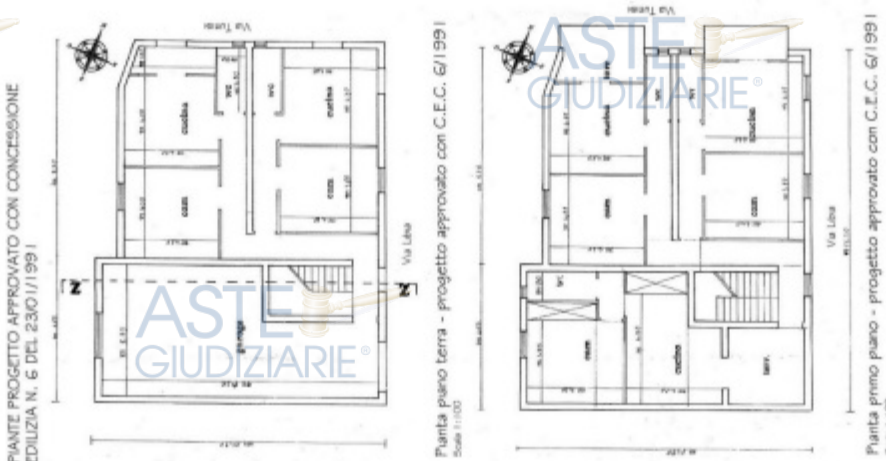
Planimetrie del progetto assentito con concessione edilizia n. 6/1991 (piano terra e piano primo).
